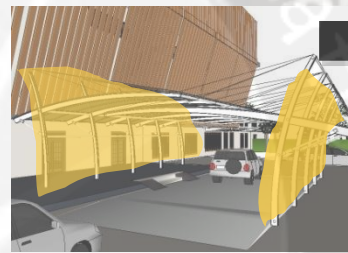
Kejelasan Struktur pada Bangunan.
